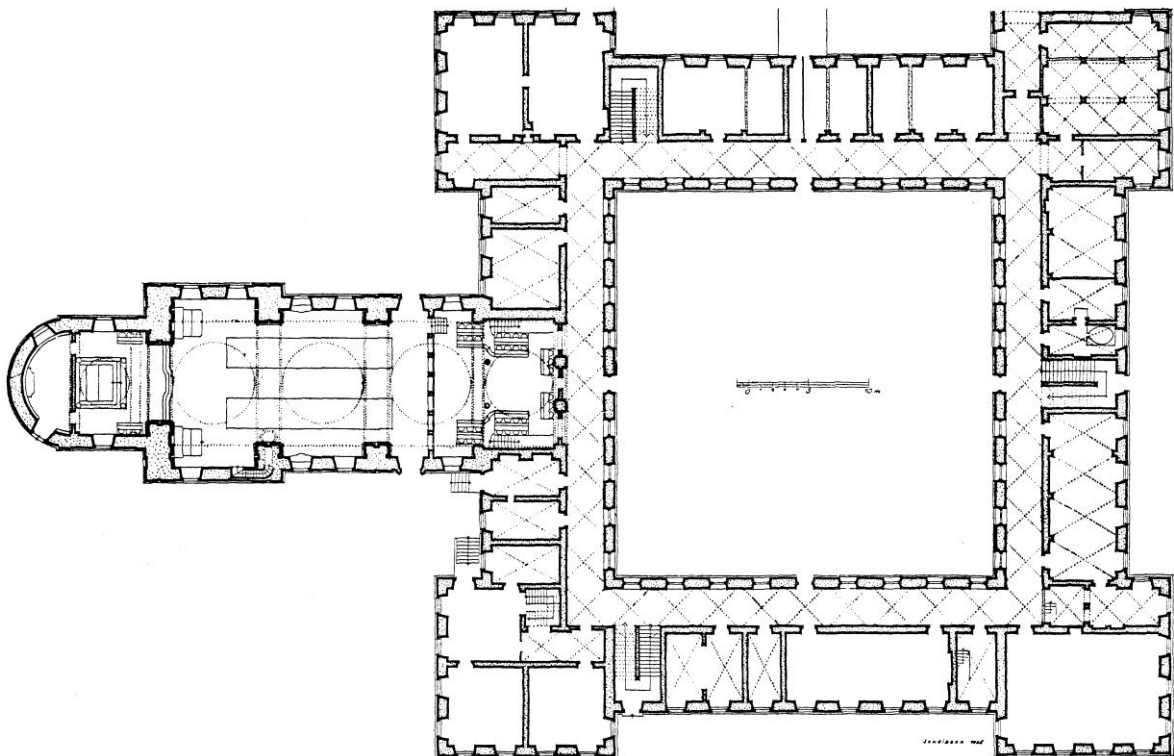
Sießen, Grundriss der Klosteranlage (der Plan ist gewestet)
